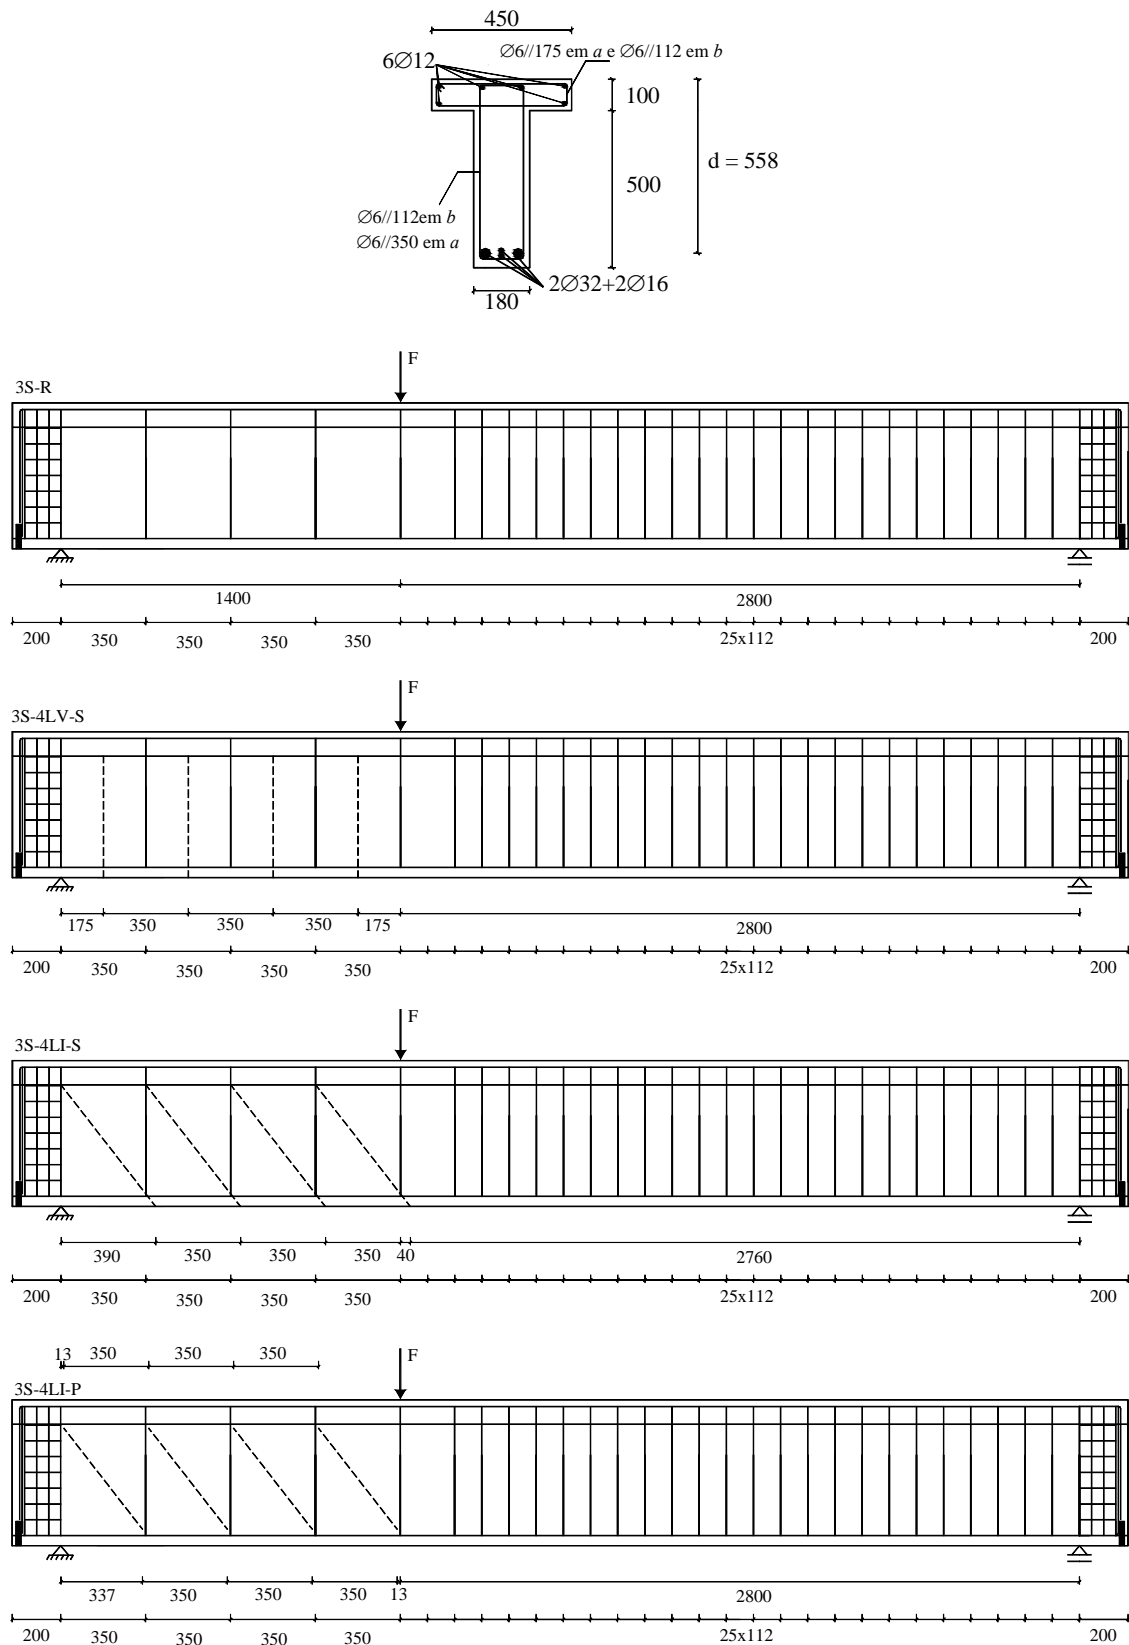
Vigas testadas por Costeira (2010) (dimensões em mm).
